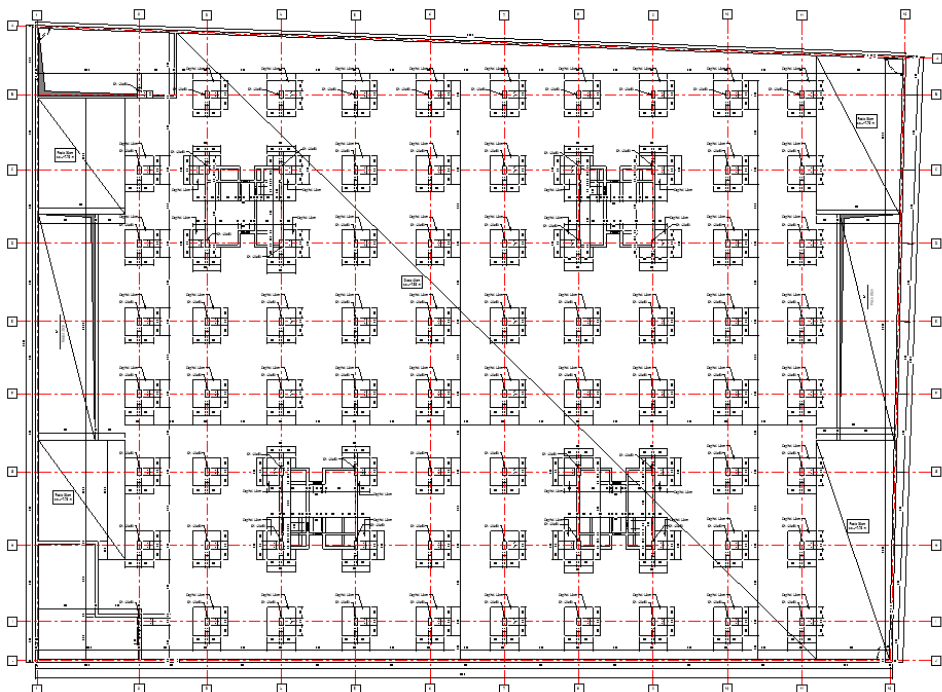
Plan cofraj planșeu peste Subsol 3
